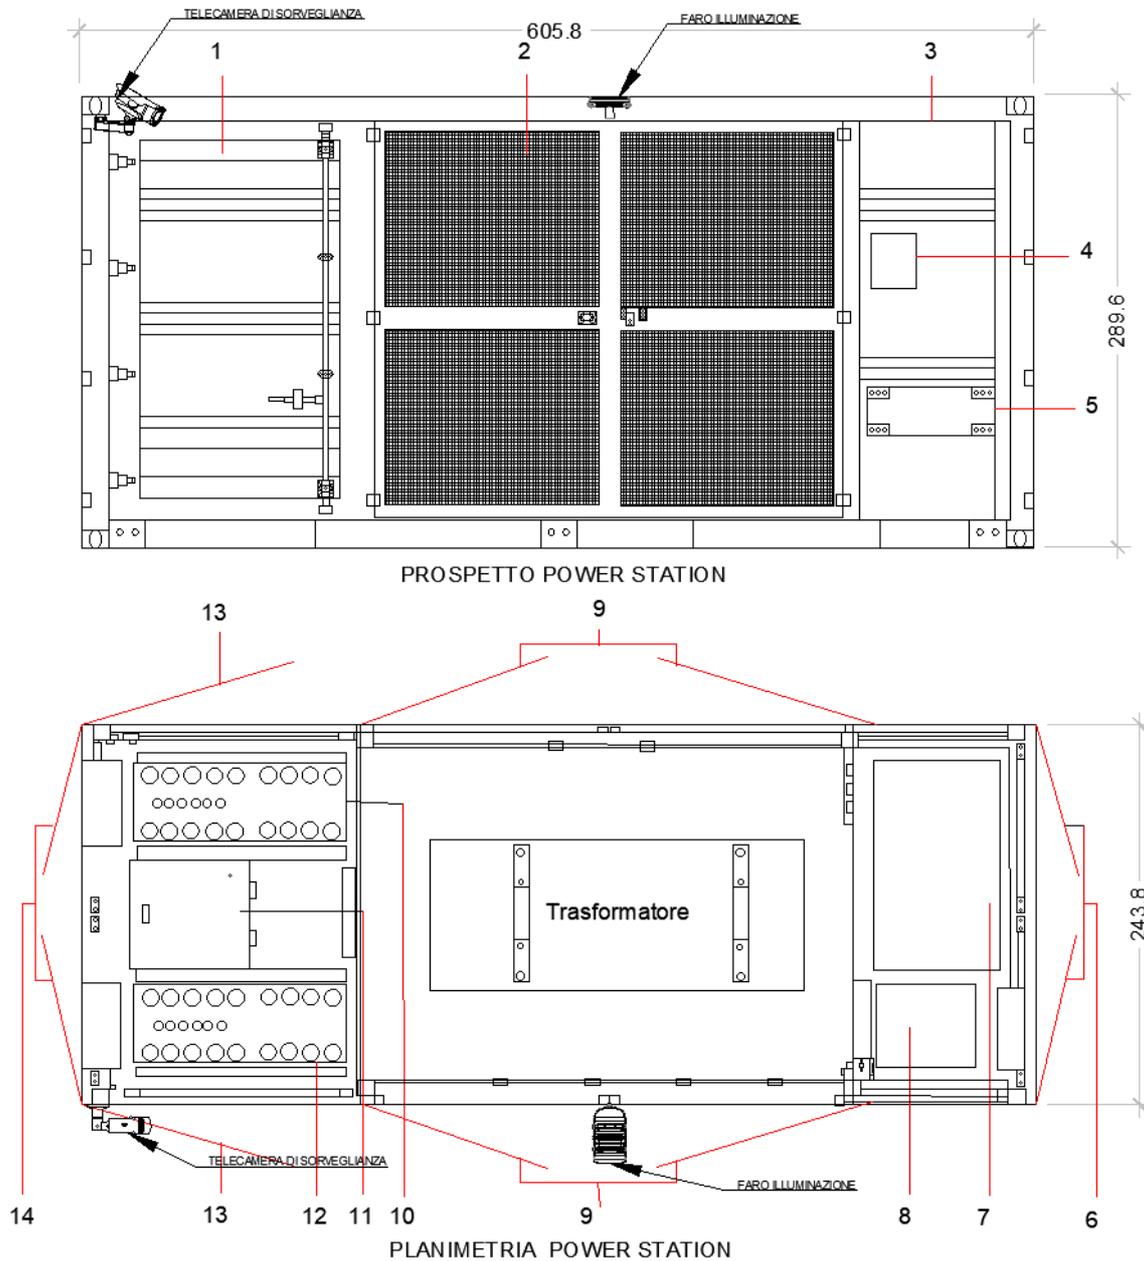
Planimetria e prospetto power station con illuminazione e videosorveglianza
